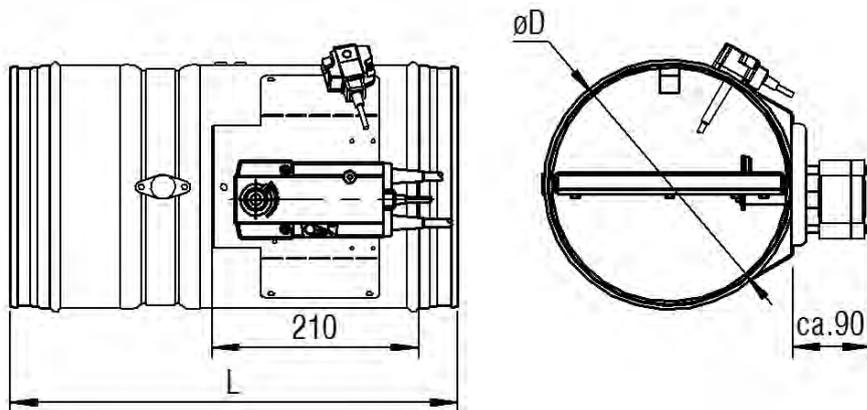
BRS mit Federrücklaufantrieb B10/B11
